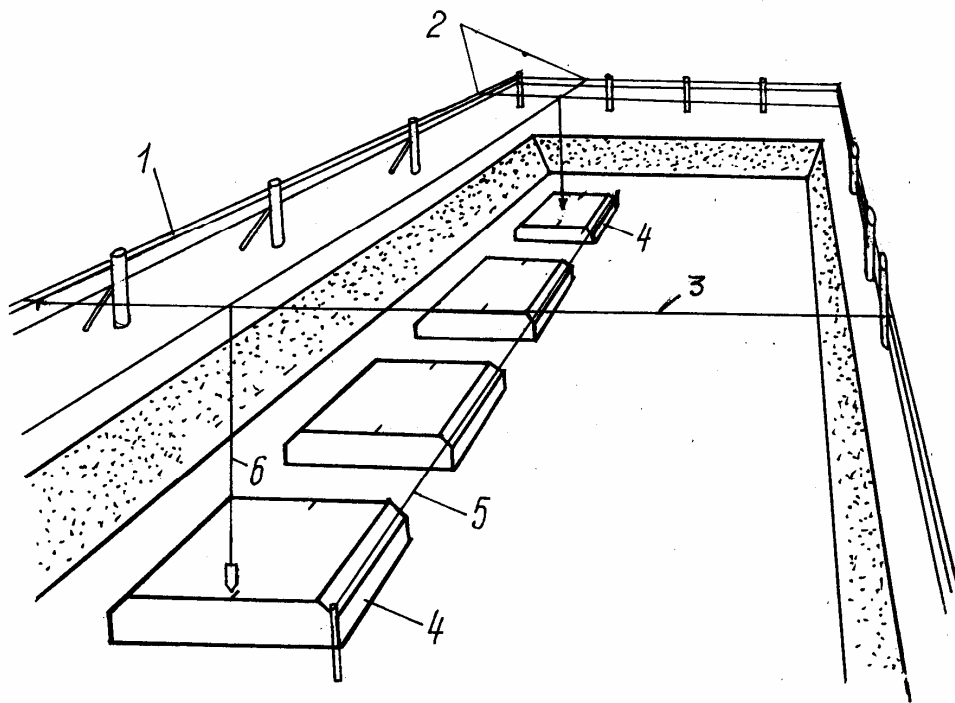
Схема перенесения разбивочных осей в котлован отвесами:
